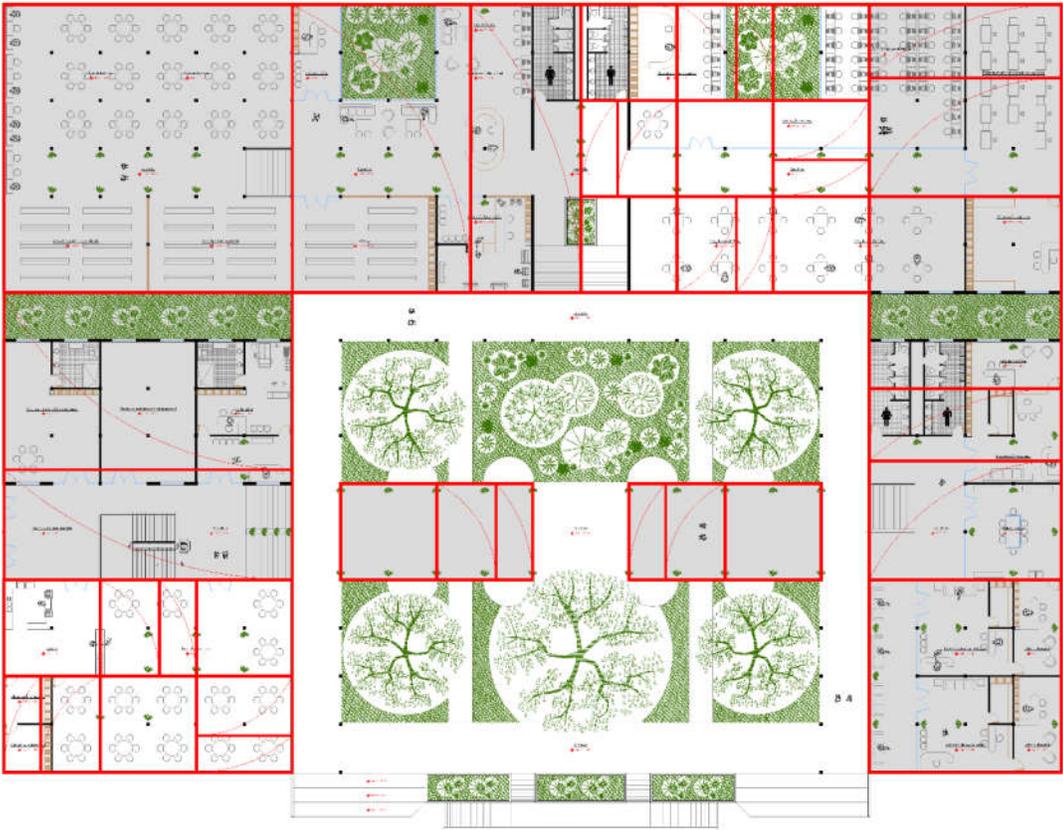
Diseño modular resaltado en planta arquitectónica baja.
